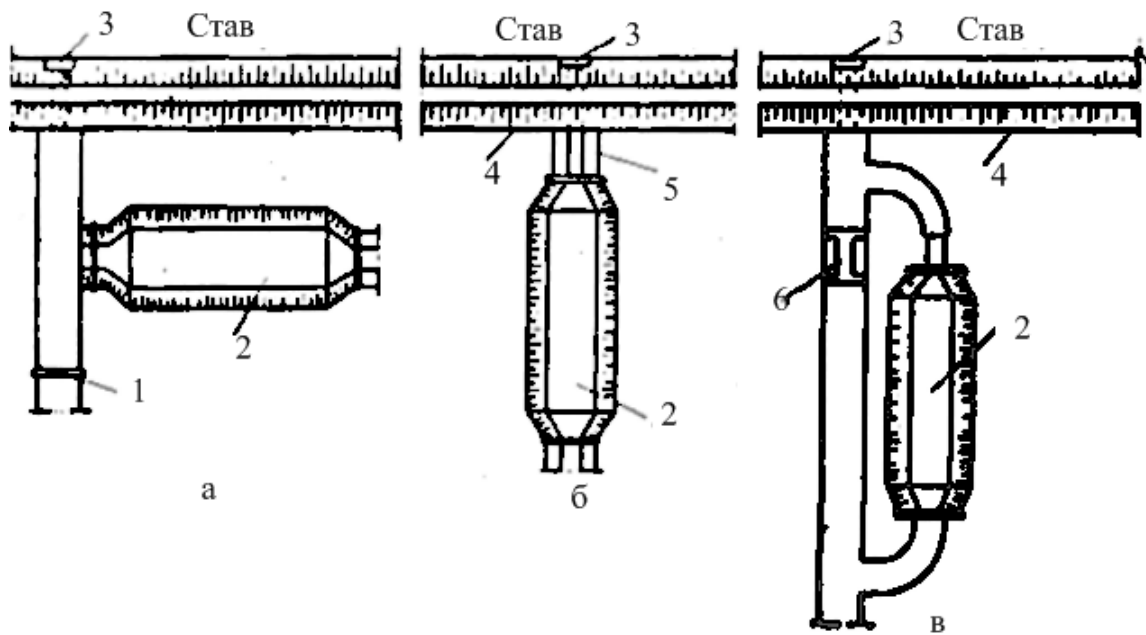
Схеми розташування рибо уловлювачів на плані:
